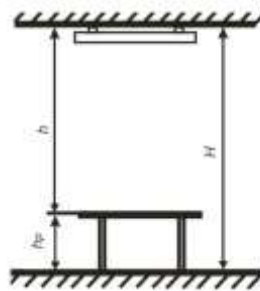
Схема розташування світильника над робочою поверхнею
